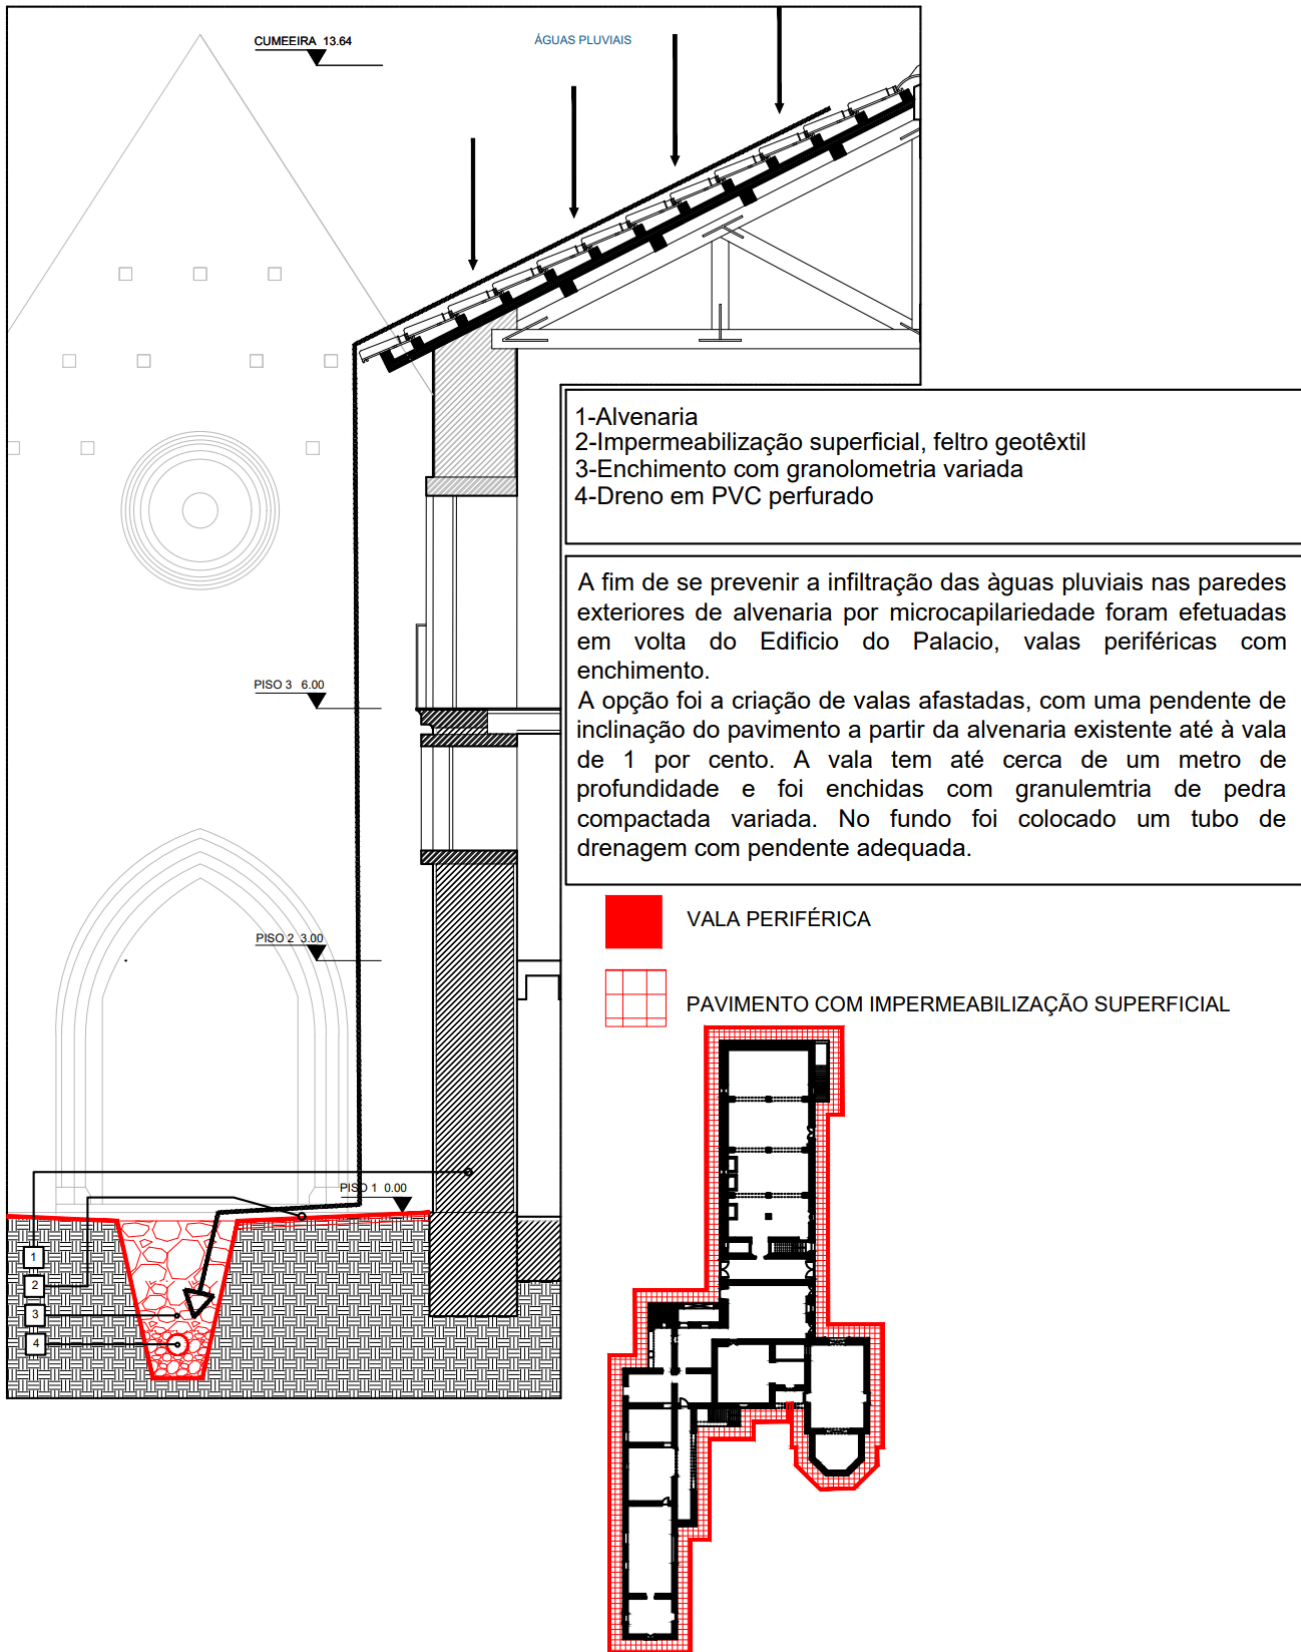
Corte construtivo, escoamento das águas Pluviais, Paço
